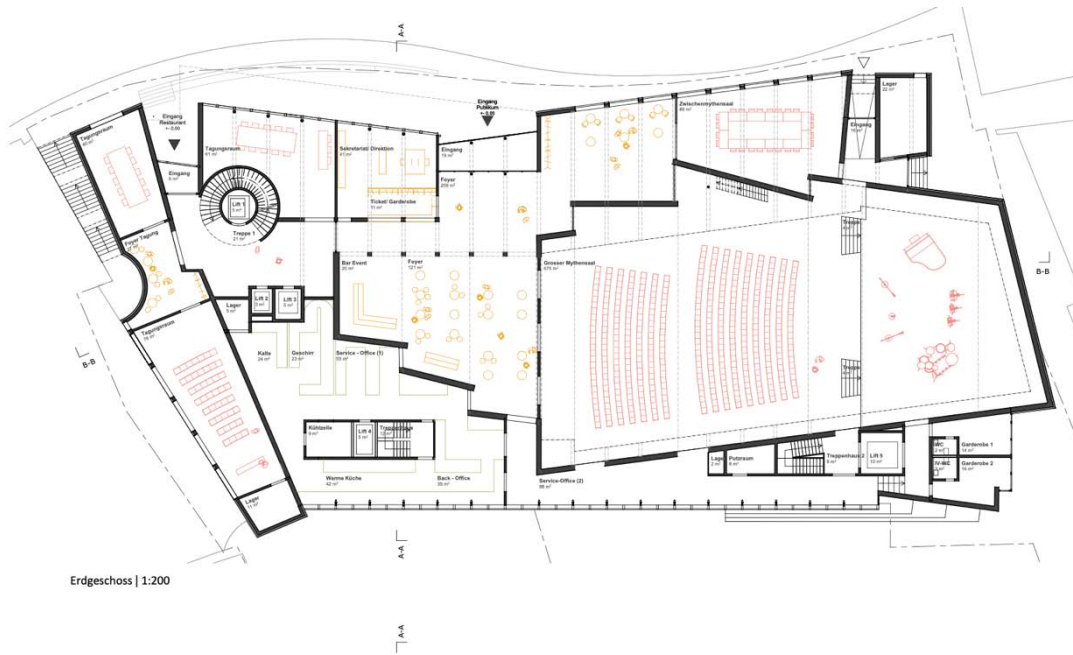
Erdgeschoss, Studie Baumschlager Eberle Zürich AG
